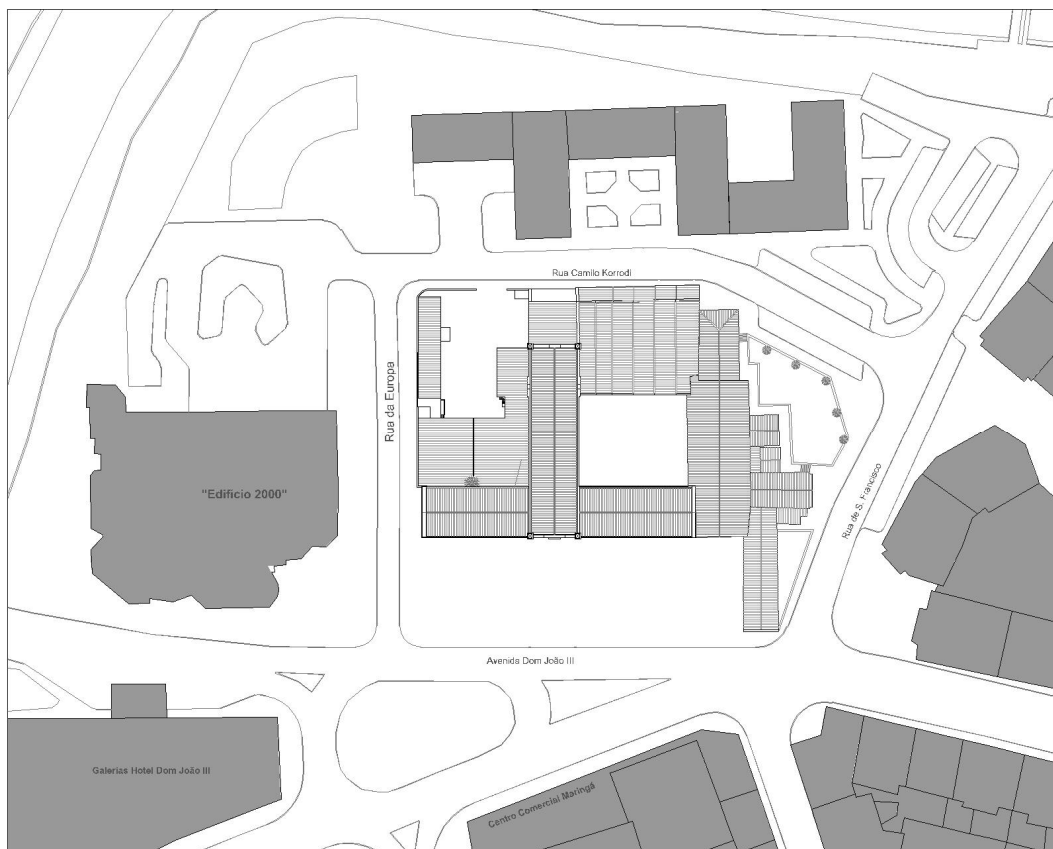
Planta de implantação do estado actual da Companhia Leiriense de Moagem.
